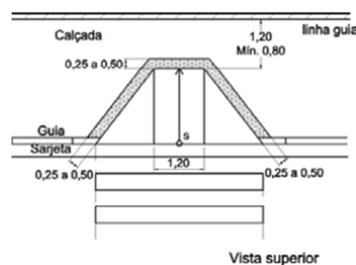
Sinalização tátil de alerta nos rebaixamentos das calçadas – Exemplo
